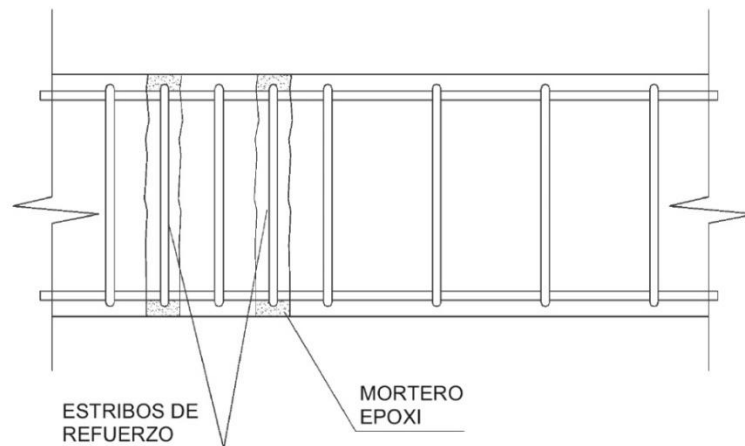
Adición de estribos para el refuerzo a cortante en vigas de hormigón armado.
